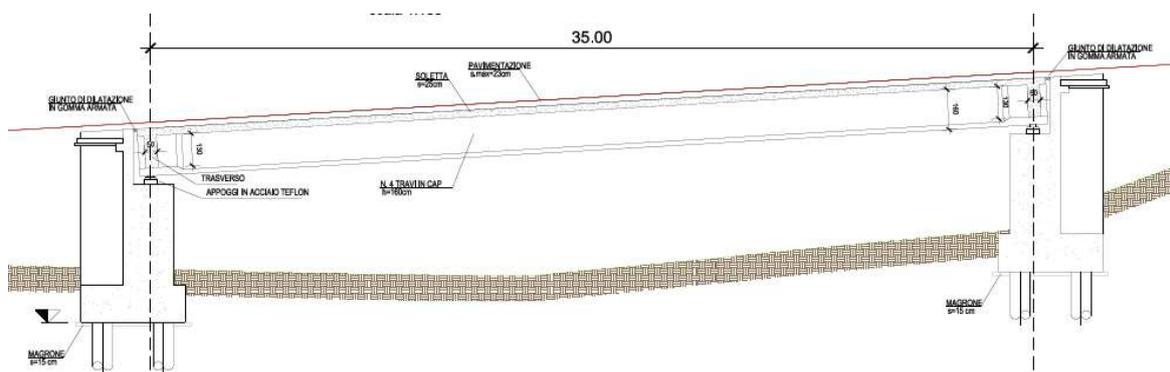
SS.260 - Lotto V - Esempio prospetto ponte
